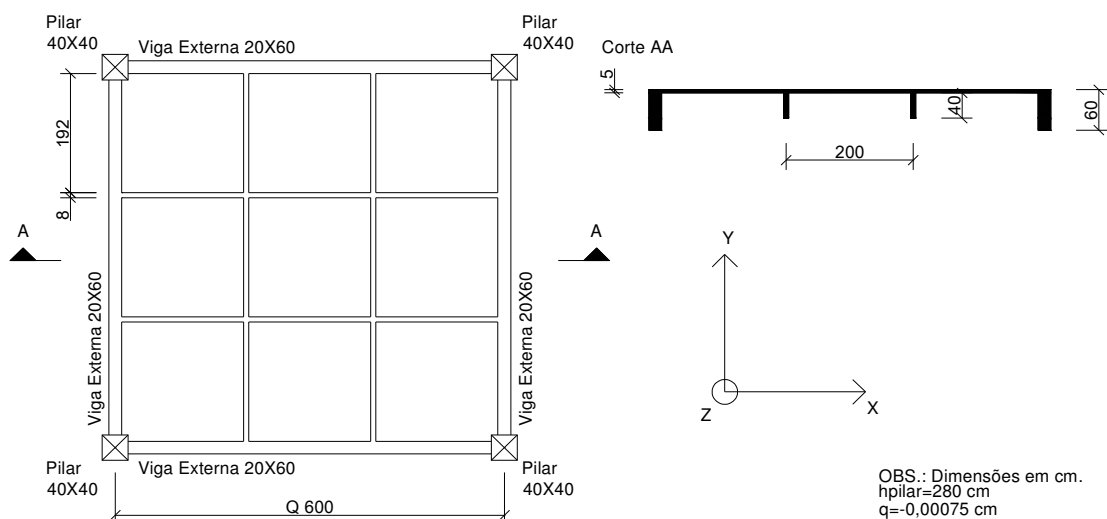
Desenho esquemático do pavimento 01 analisado n° de nervuras=2.
